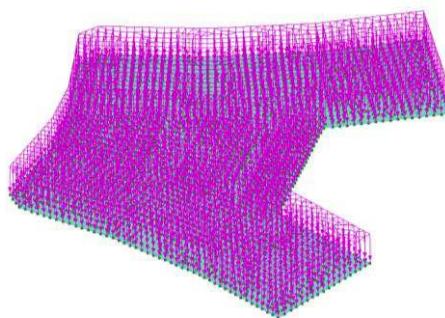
Нагрузка от кровли верхнего этажа
